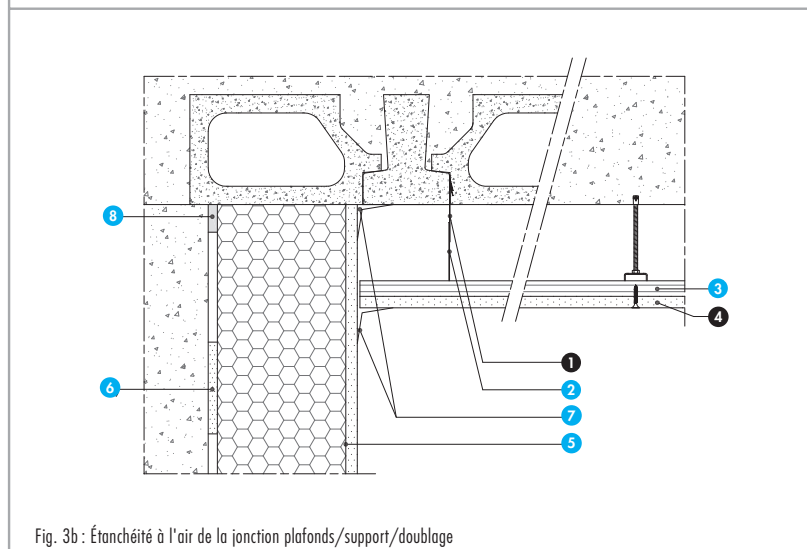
Étanchéité à l'air de la jonction plafonds/support/doublage
